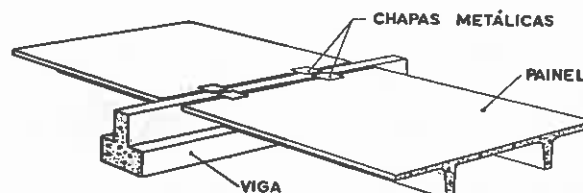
Apoio de painéis TT sobre vigas (3)
